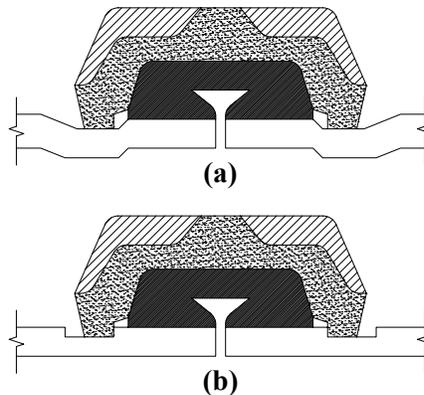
Detalle de unión de tuberías ranuradas: (a) moldeadas y (b) talladas
